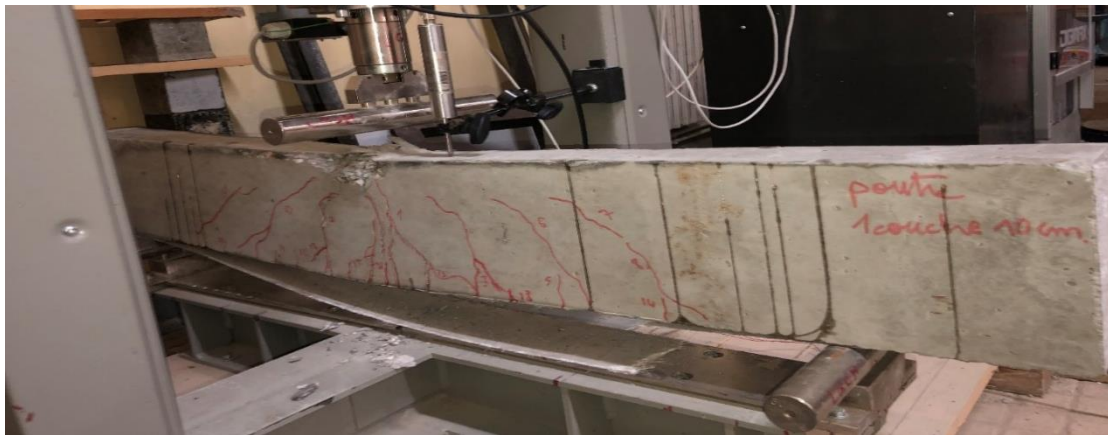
Rupture de la poutre renforcée (P1-10).
